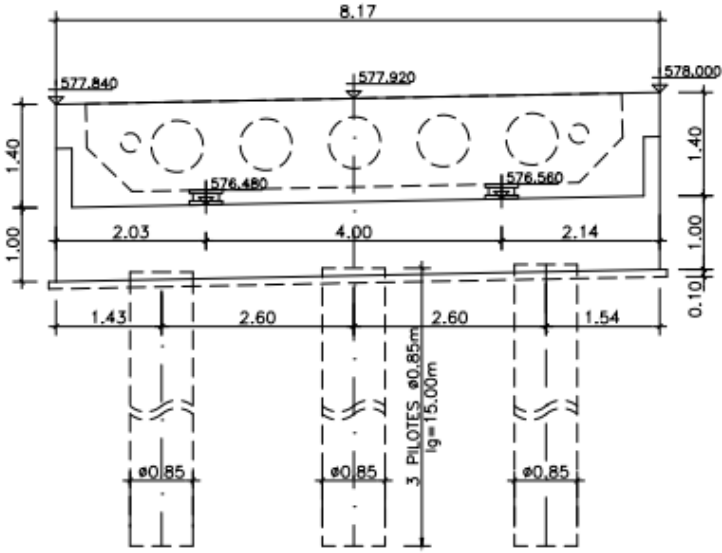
Alzado estribo P.S. eje 75 (se observa también la losa de hormigón armado)
